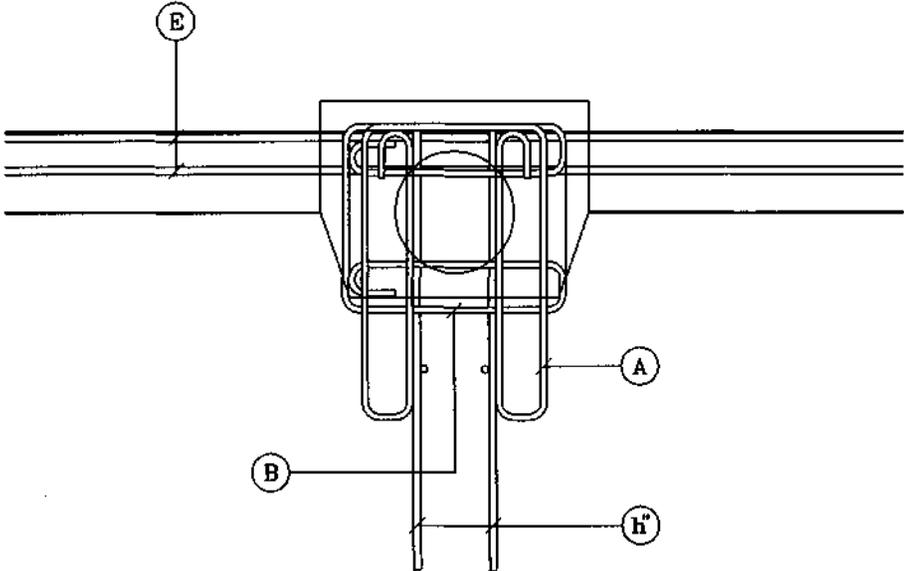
Détail dans le plan de la plaque d'ancrage
